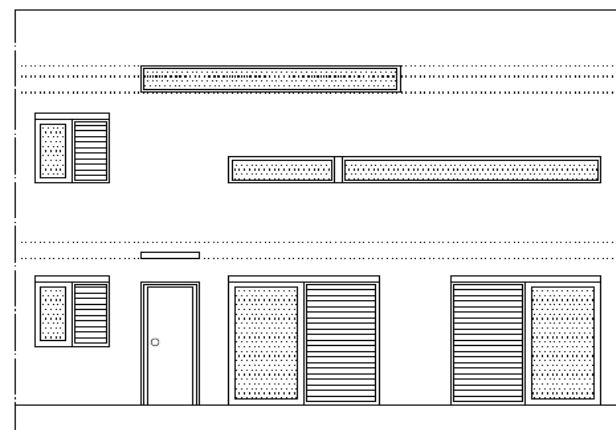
8 – Fachada norte de la Passivhaus propuesta
